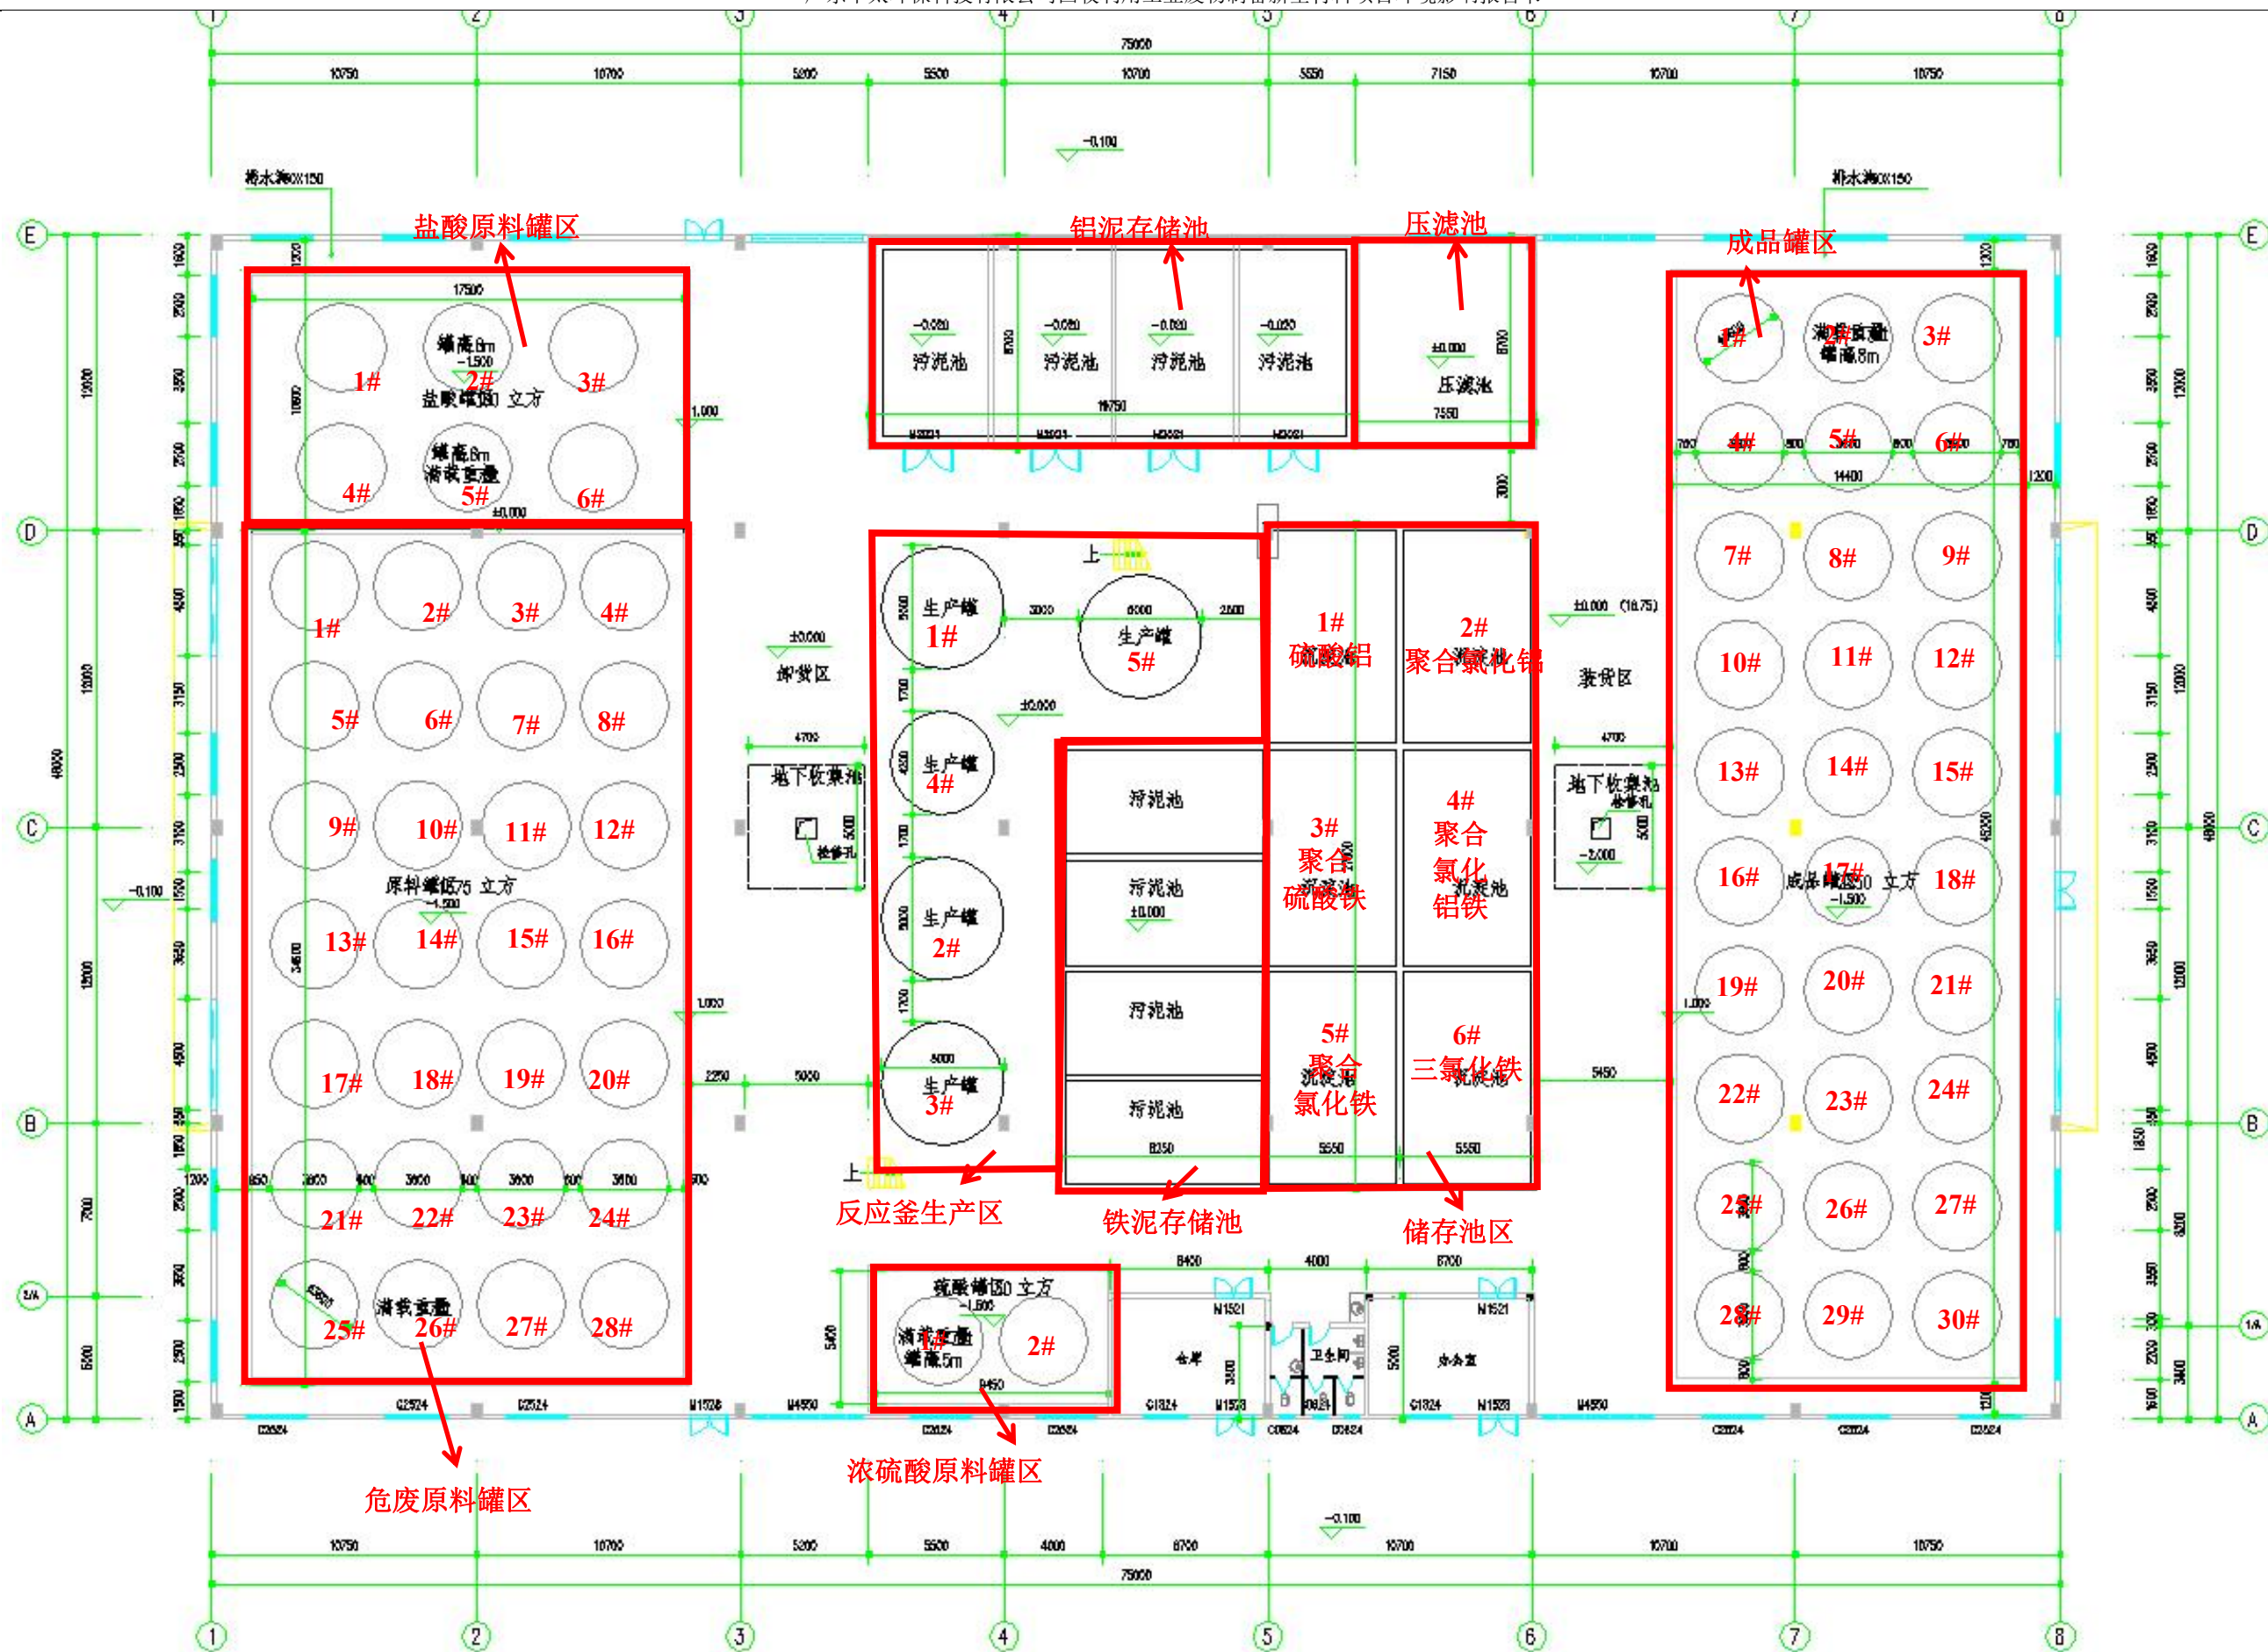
净水剂生产车间（车间一层）平面布置图
